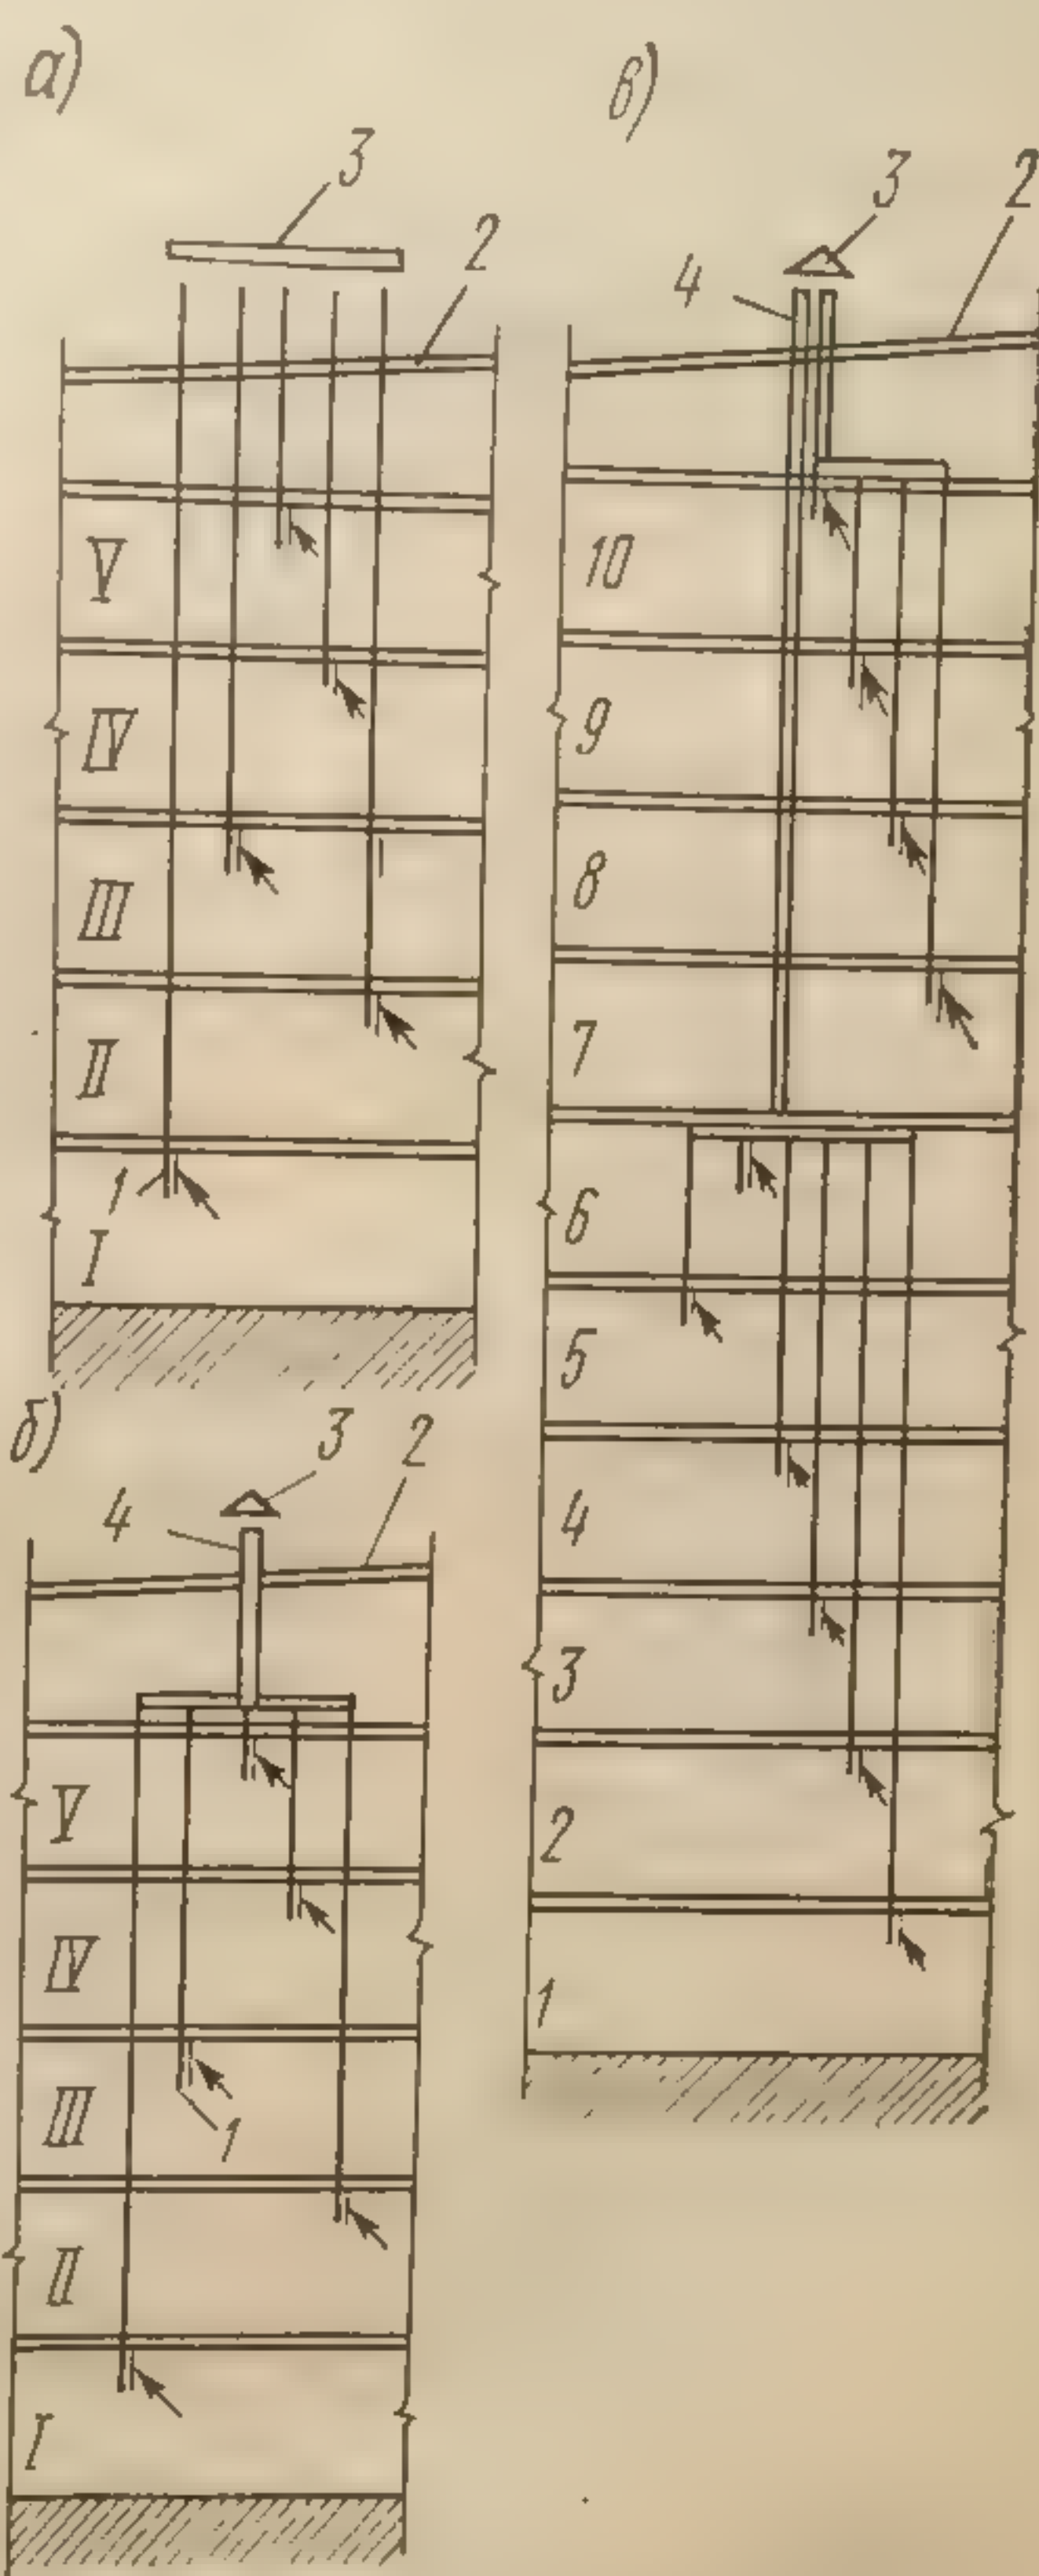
Схемы систем вытяжной вентиляции с вертикальными каналами:
